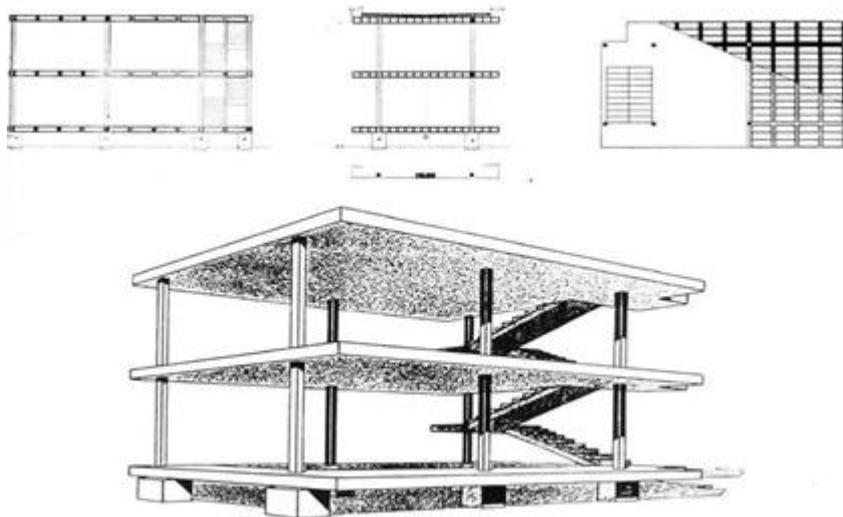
Sistema *Dom-ino*, perspectiva, planta e secções
